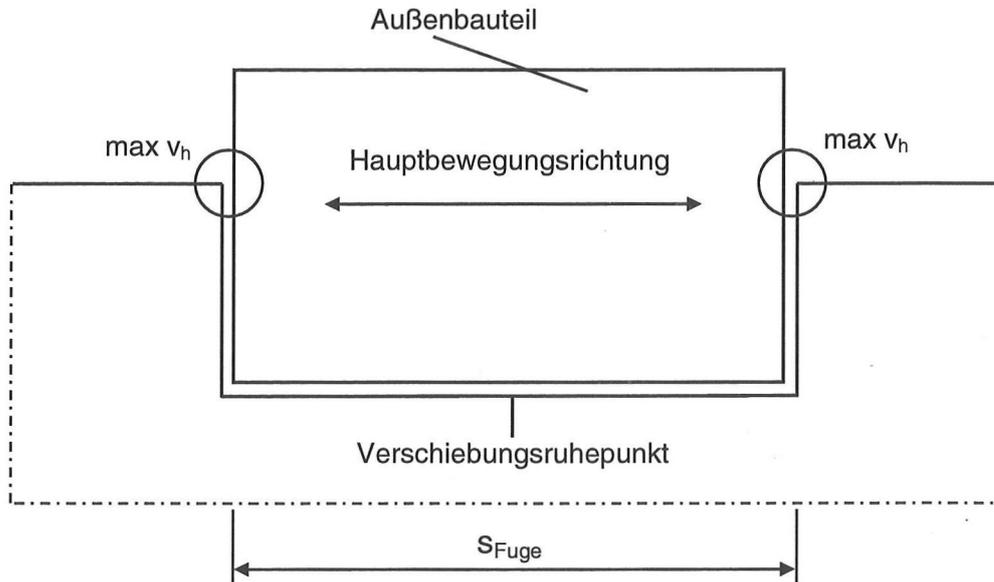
Einbausituation mit Lagerung an gegenüberliegenden Platten
